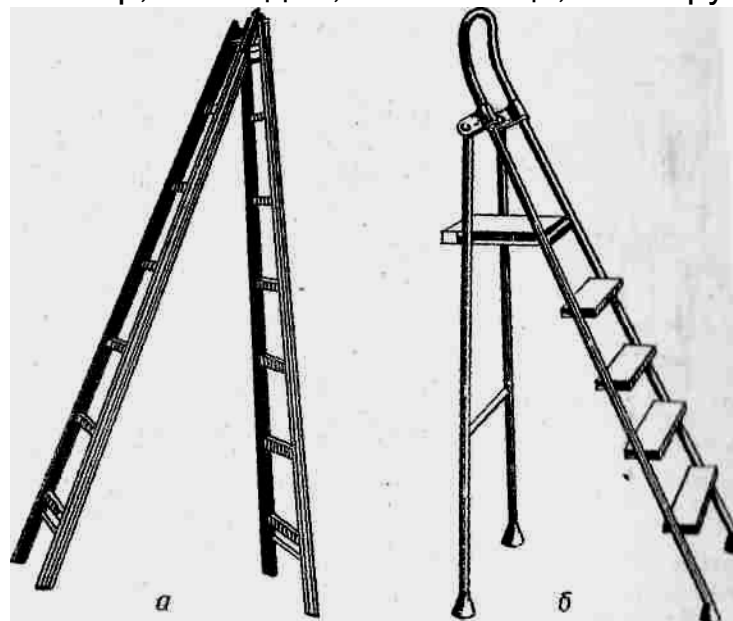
Розсувні драбини: а — дерев'яна; б — металева
